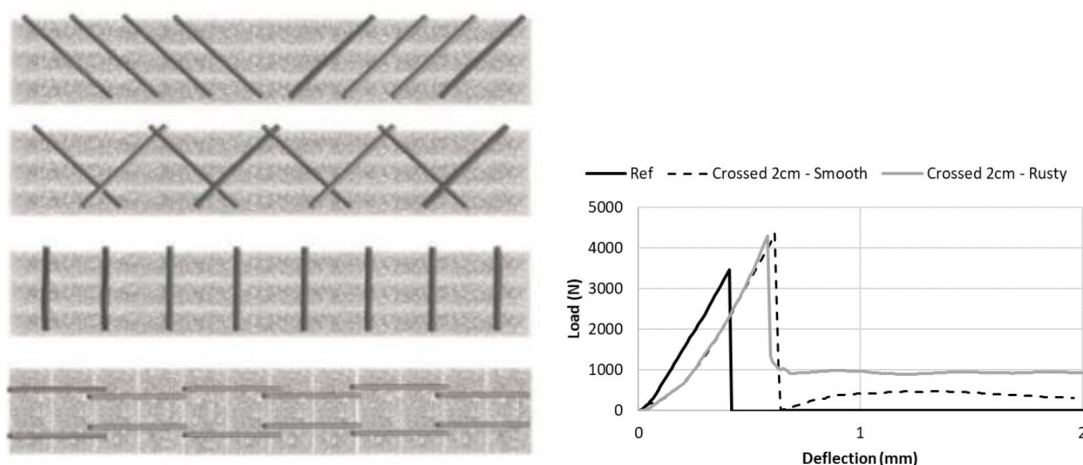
Schéma de la stratégie de renforcement par ajout de vis entre les couches et courbes force-déplacement en essai de flexion multicouche mettant en évidence une amélioration de la ductilité par le renforcement.
